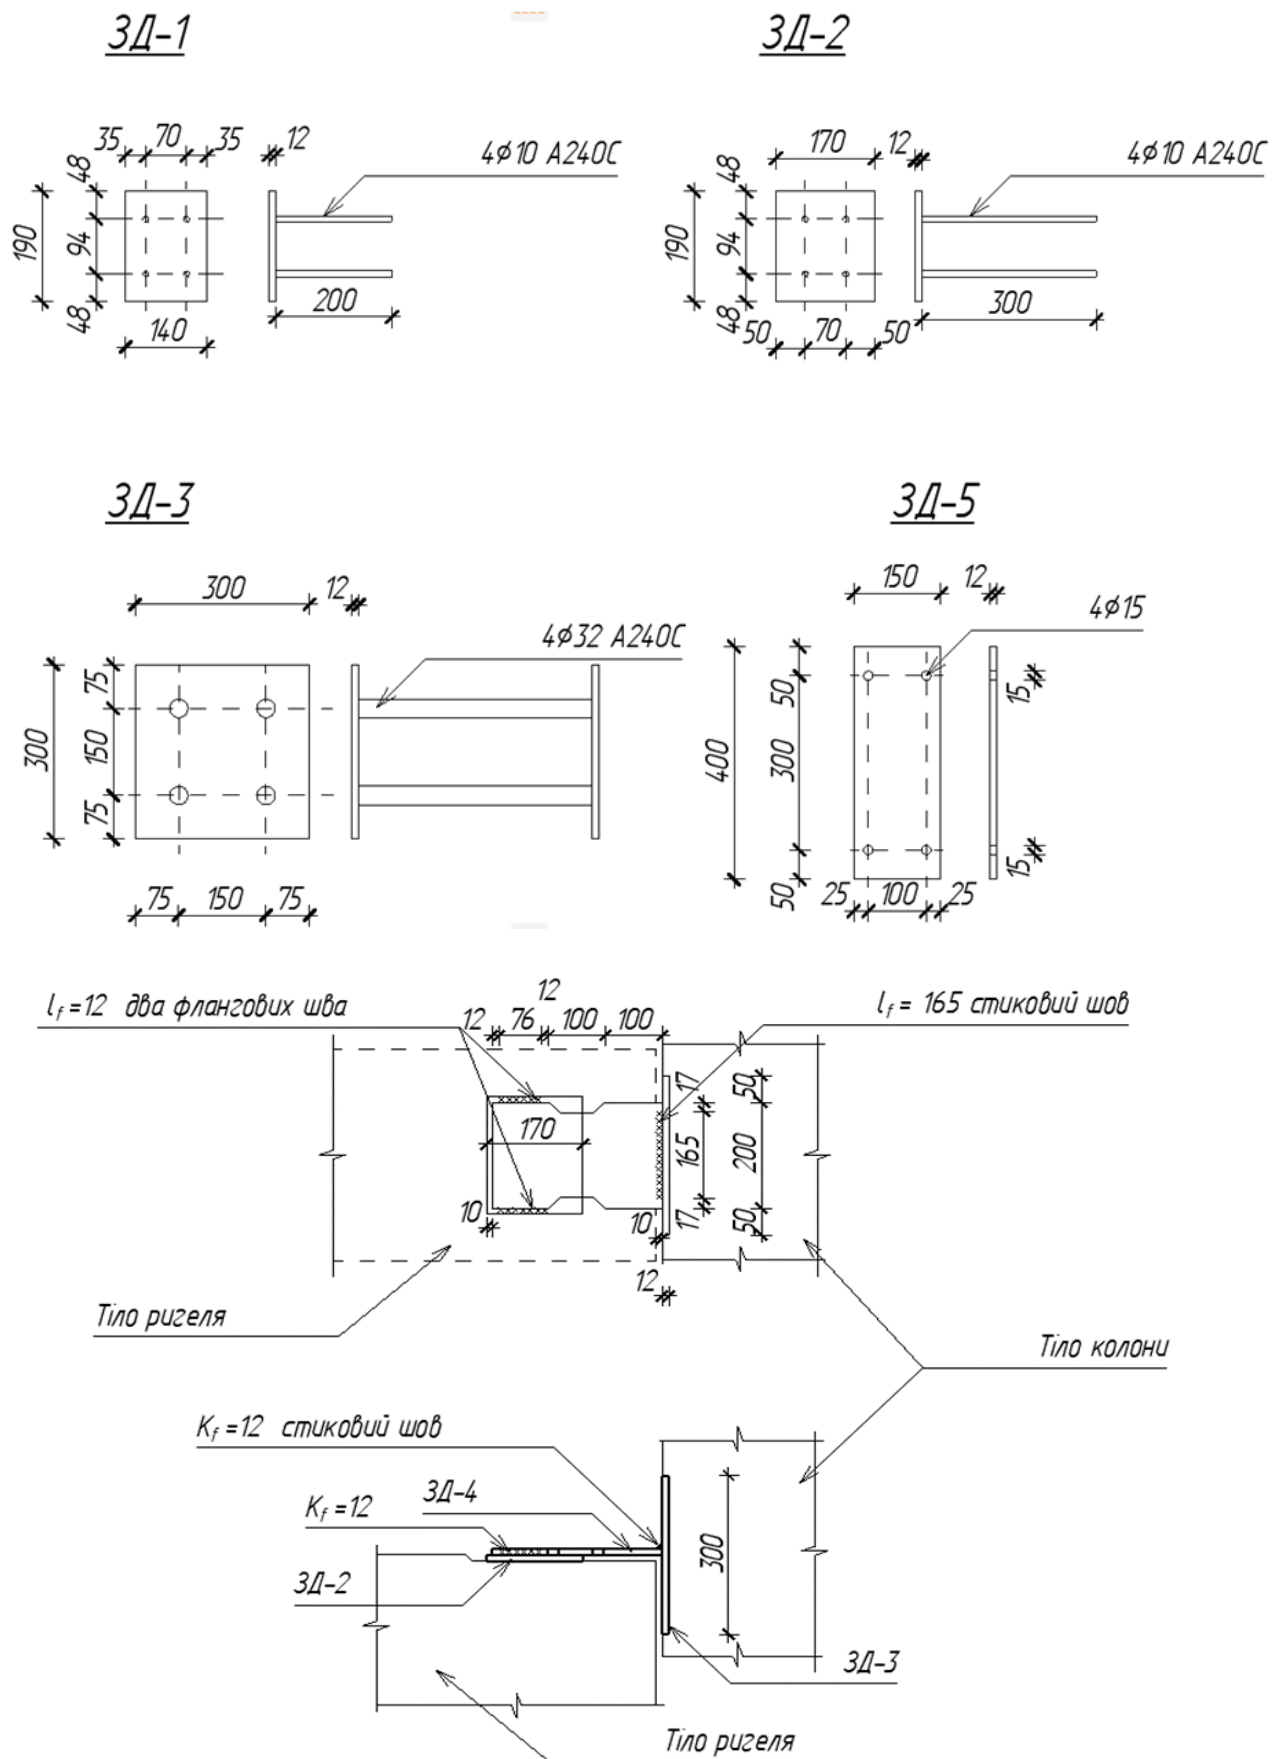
Схема зварювання частин закладних деталей, Закладні деталі
